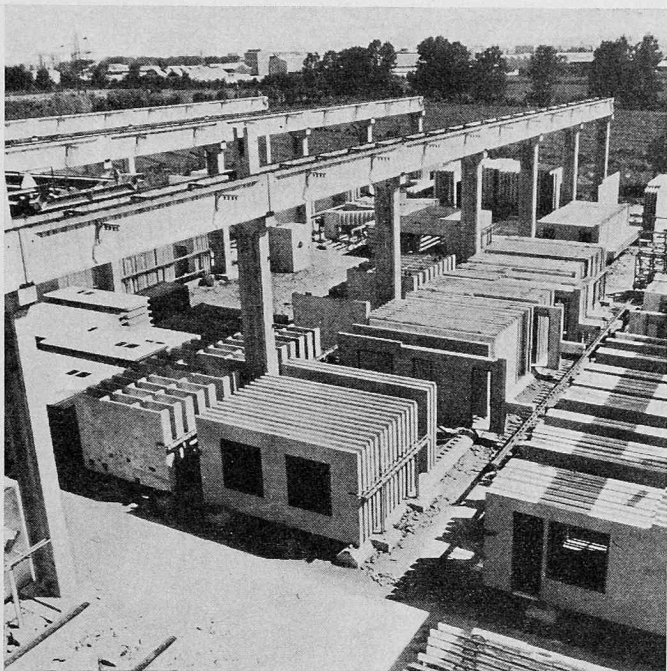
Wohnbaufabrik in Mailand, Lagerplatz mit vertikal gelagerten Grosselementen (System SACIE-Koncz)
